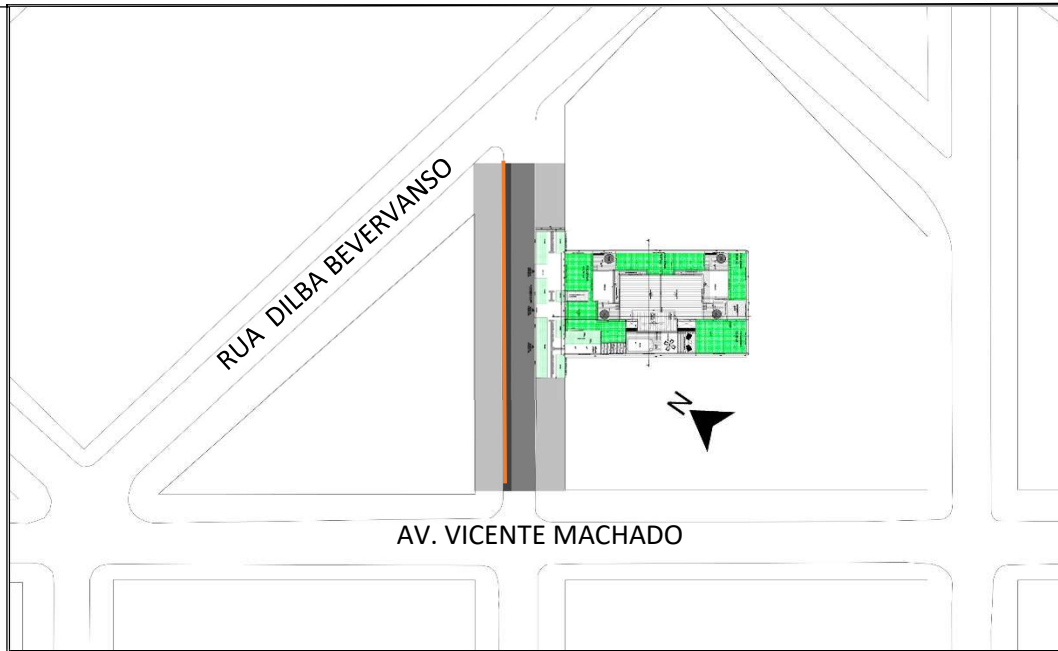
CALÇADAS LOCAIS EXISTENTES
